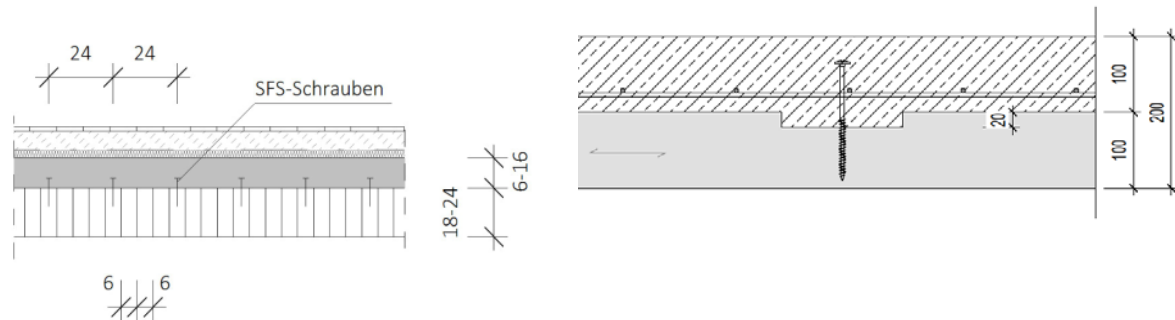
Querschnitt einer HBV-Decke mit SFS-Schrauben [205] Längsschnitt HBV-Decke mit Kerfen
